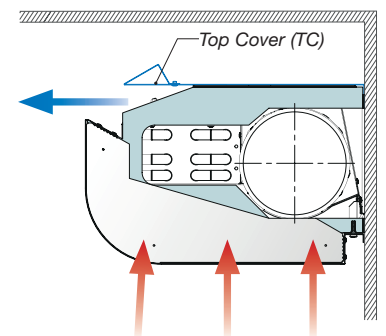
Plafond XD-FW Installation an der Wand, mit Abstand zur Decke (FW).
